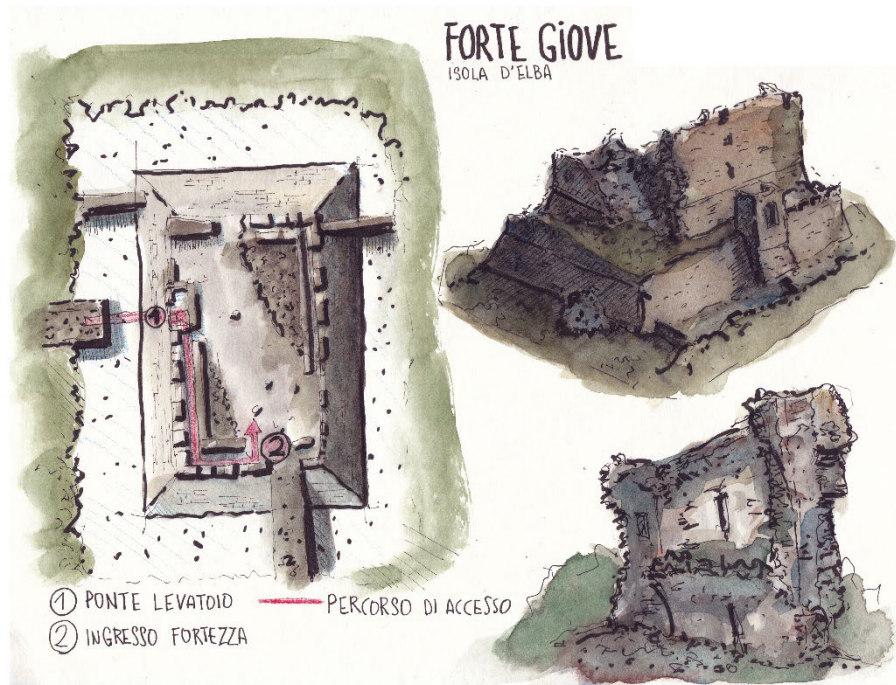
Forte Giove - Isola d'Elba - vista planimetrica e viste di insieme (disegno M. Pucci 2023)
